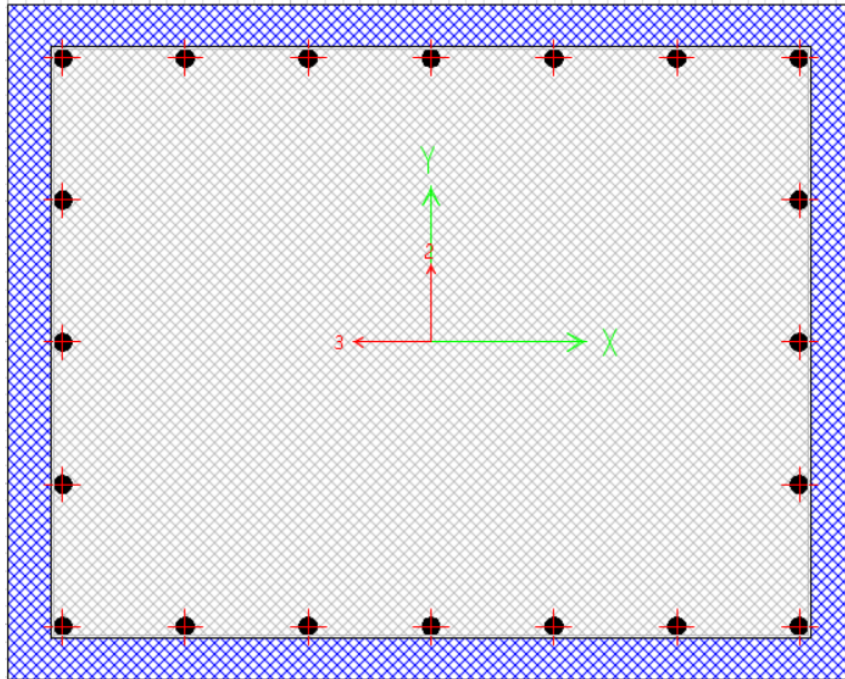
Detallamiento de columna. Fuente: SAP 2000
